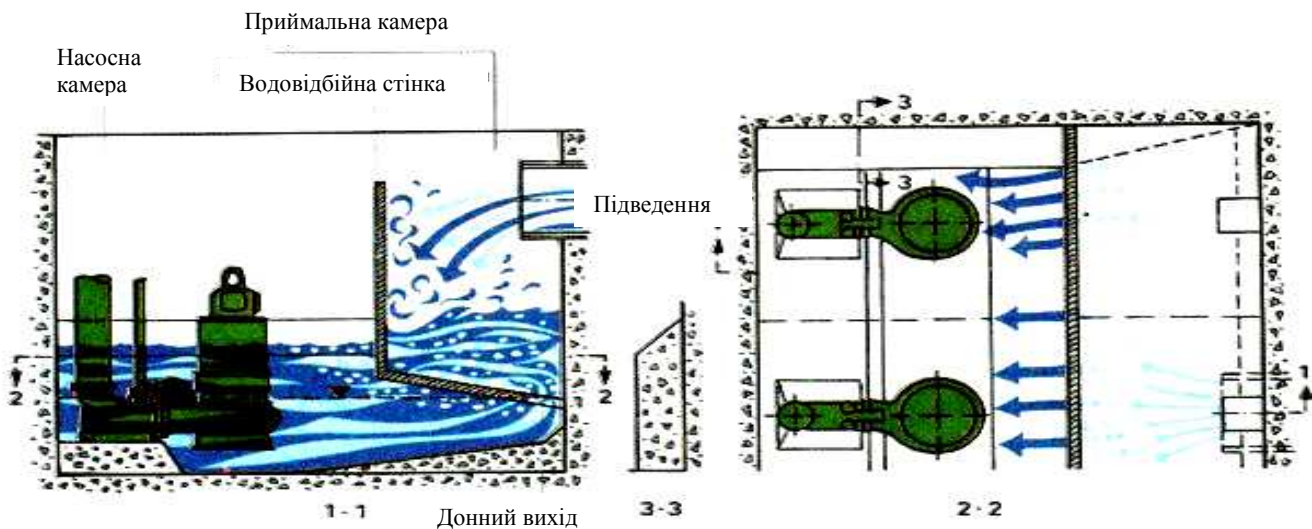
Принципова конструкція насосно-приймального резервуара
